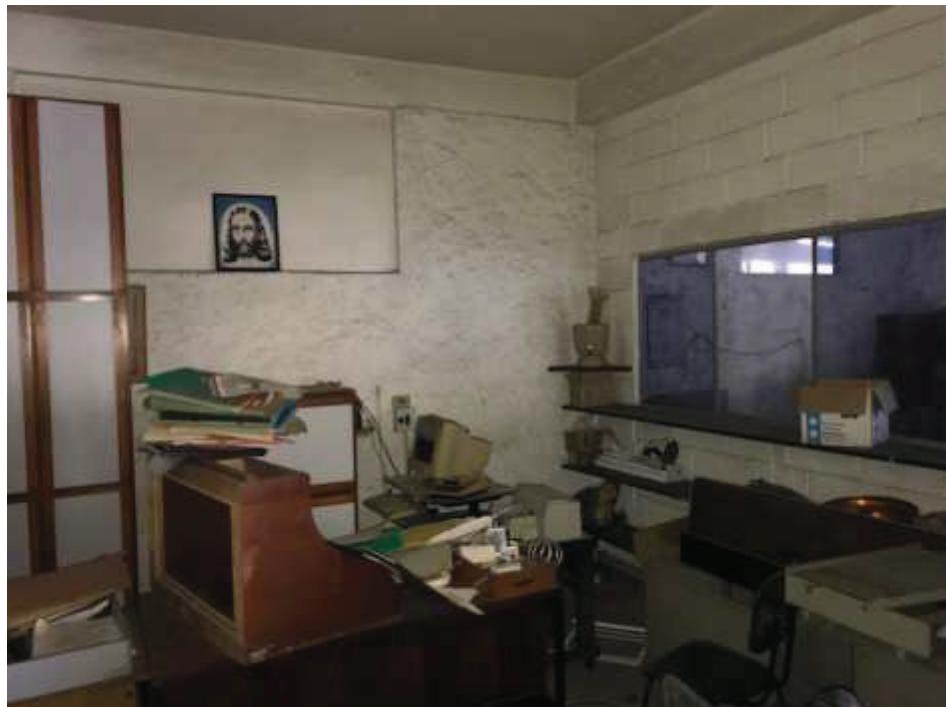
Ligação interna entre o galpão anexo e o principal.
